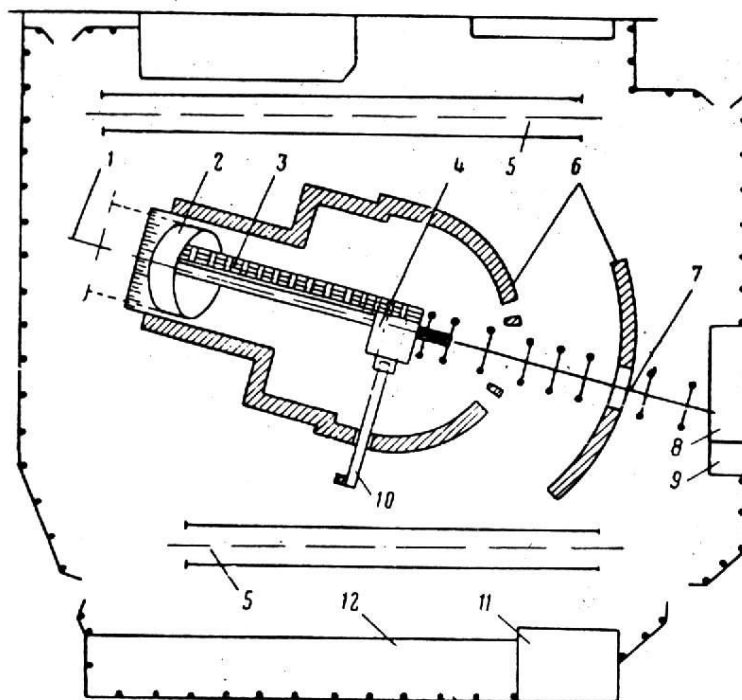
Строительная площадка при сооружении наклонного тоннеля и вестибюля по параллельной схеме:
